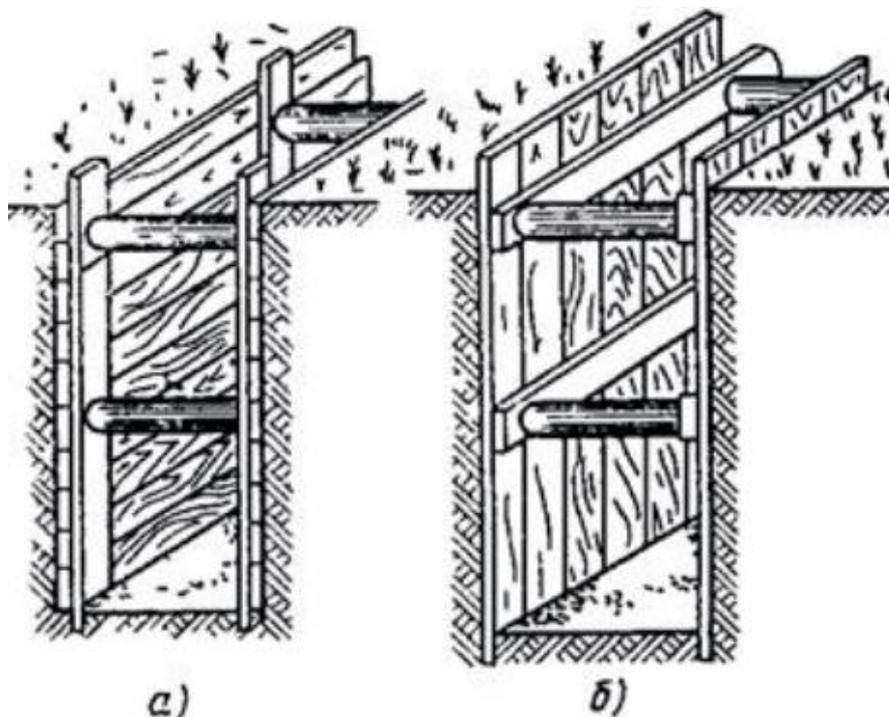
Схема вертикальных креплений откосов котлованов и траншей глубиной до 3 м деревянными досками: а – горизонтальное; б – вертикальное
